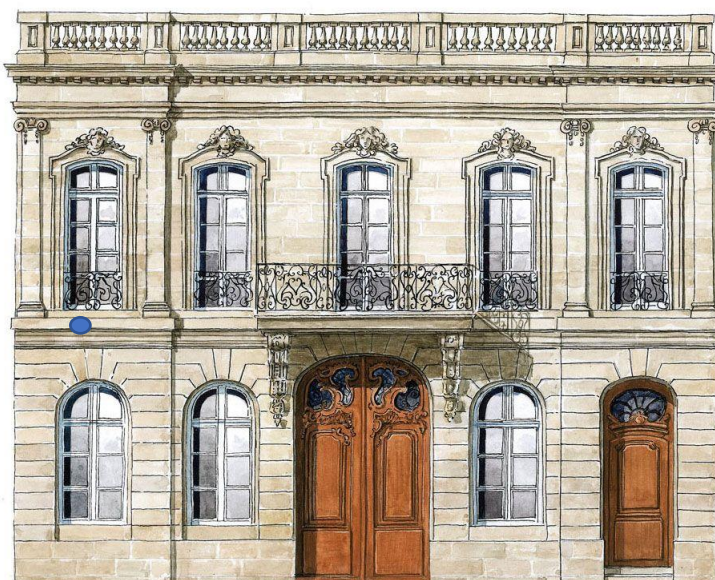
33 idées de façade haussmannienne, dessin, architecture – Pinterest (site consulté le 05-02-2022)
